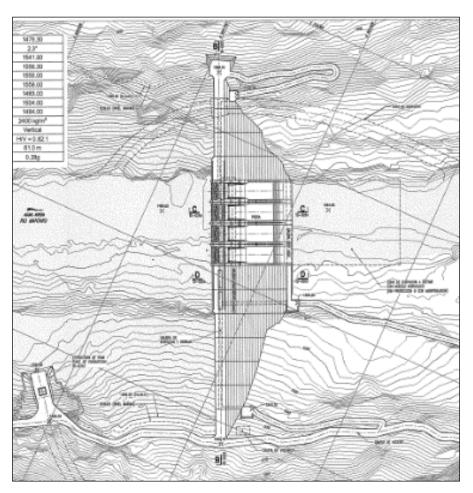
Planta de la Presa – Ingeniería Básica Cliente (Fuente: CRM)
